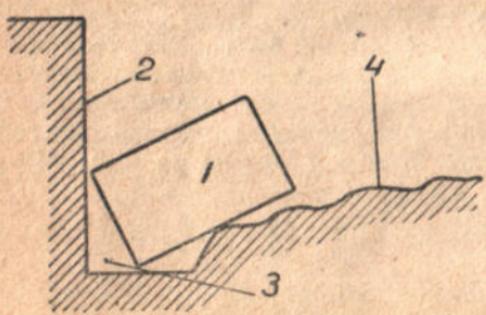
Положение ковша в боковой канавке: 1 — ковш; 2 — борт карьера; 3 — канавка; 4 — поверхность карьера.
